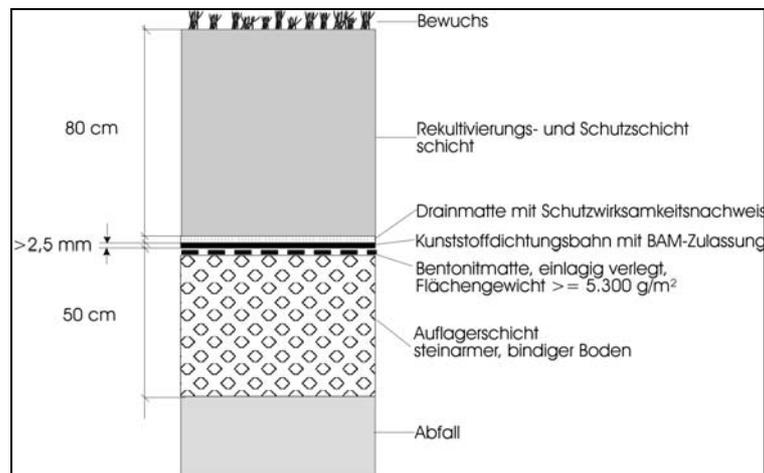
Dichtungsaufbau alternatives geotextiles Dichtungssystem
